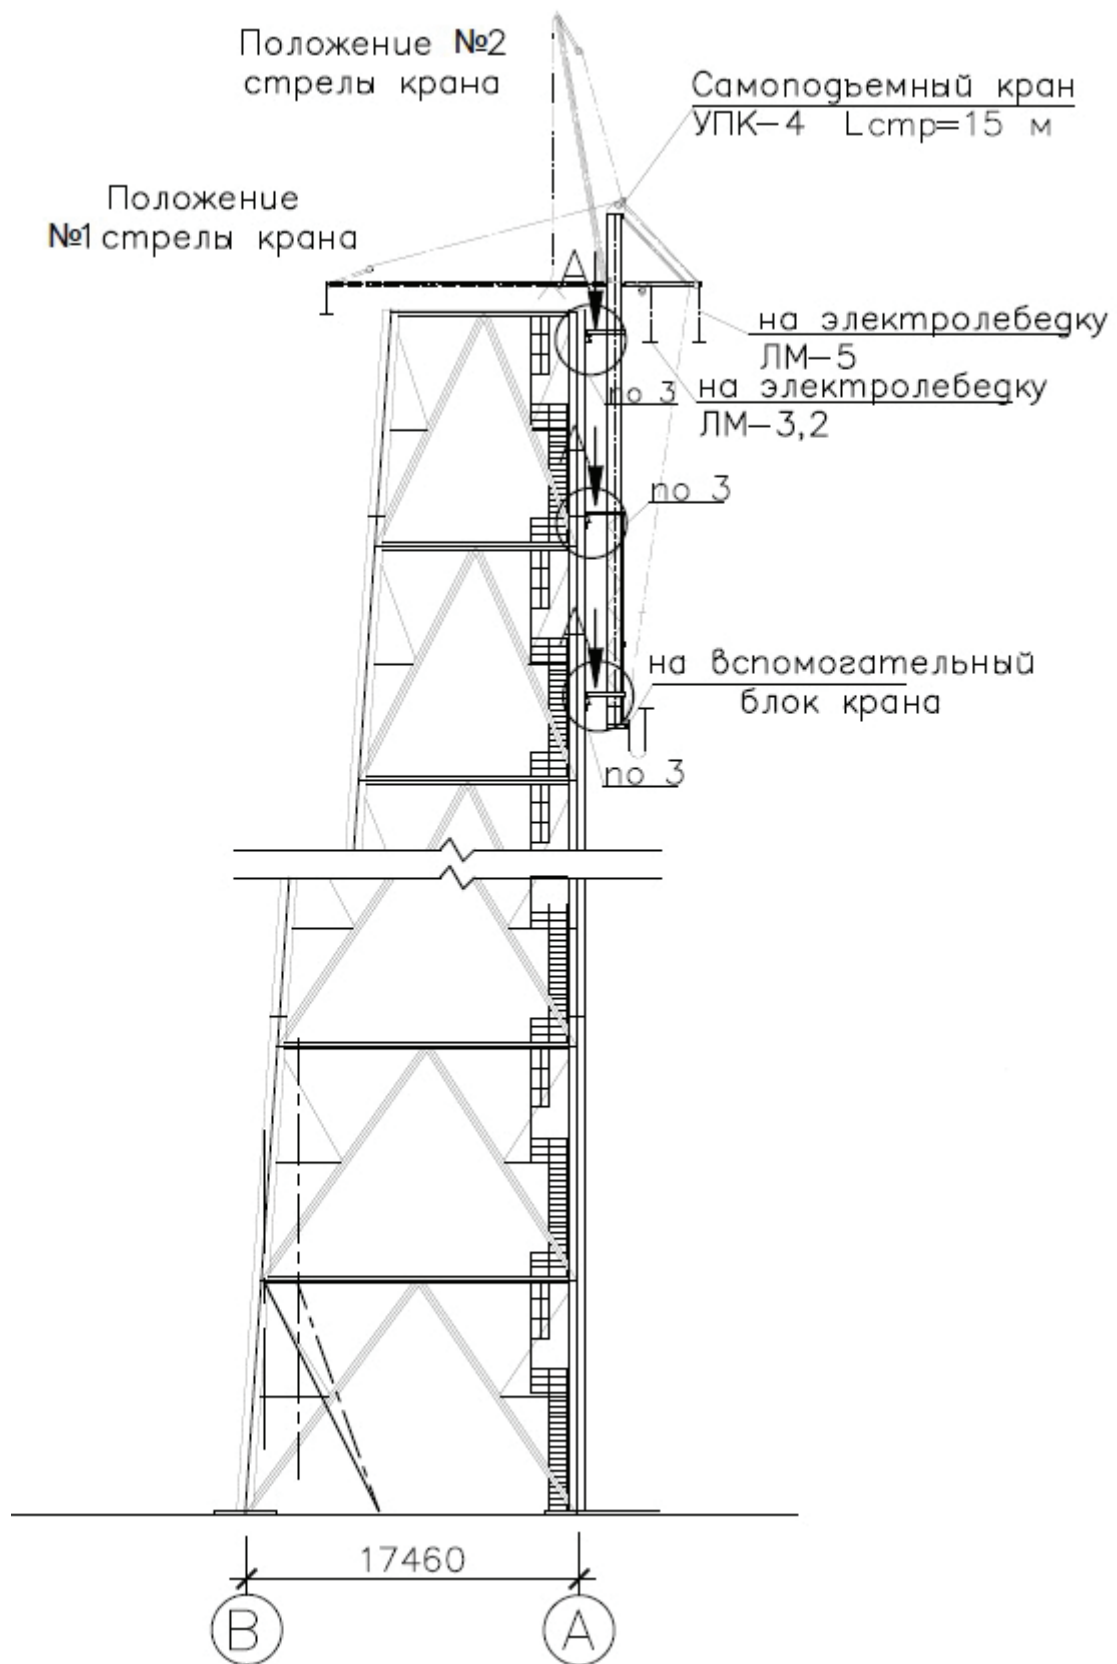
Схема монтажа секций выше 48 м краном УПК-4
